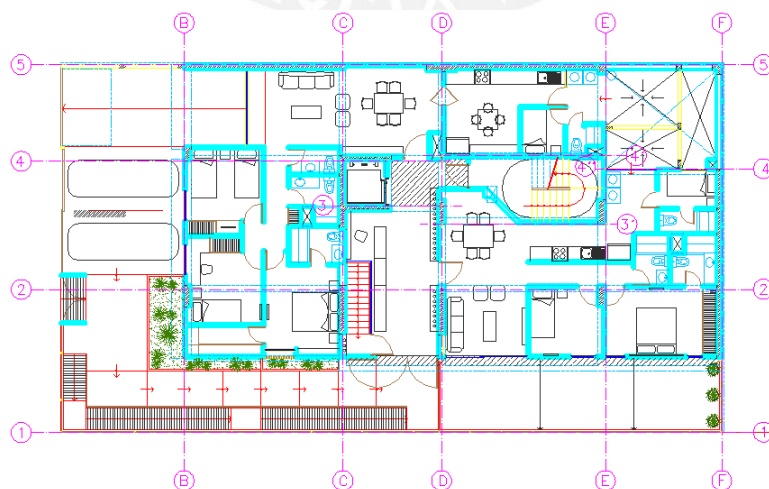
Planta del Primer Nivel – “Ejes del Proyecto”
